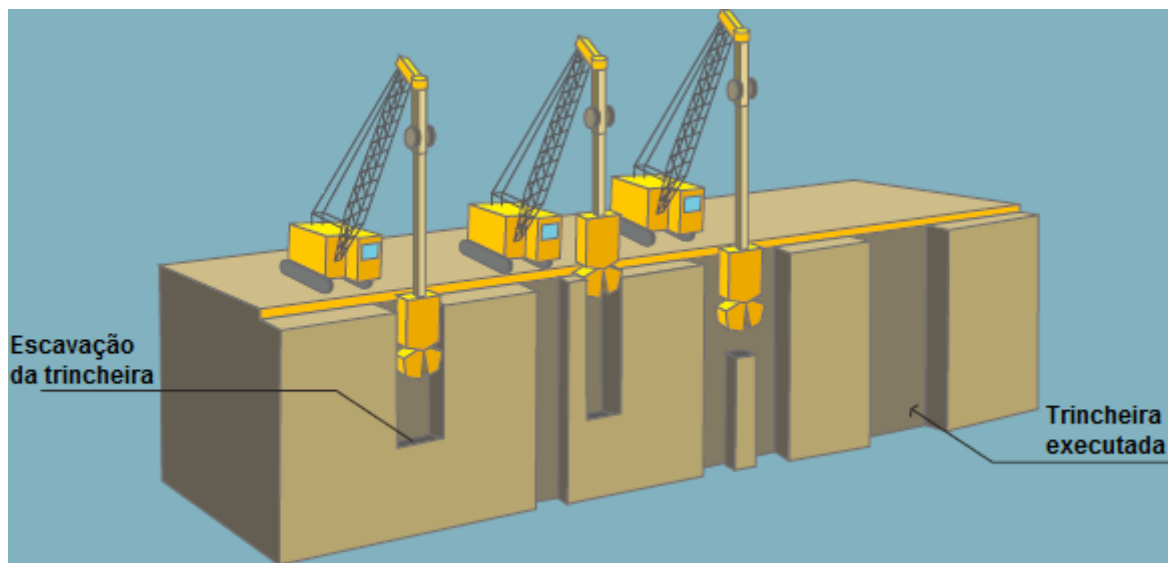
Esquema representativo da escavação de uma trincheira para a execução de um painel [83]
